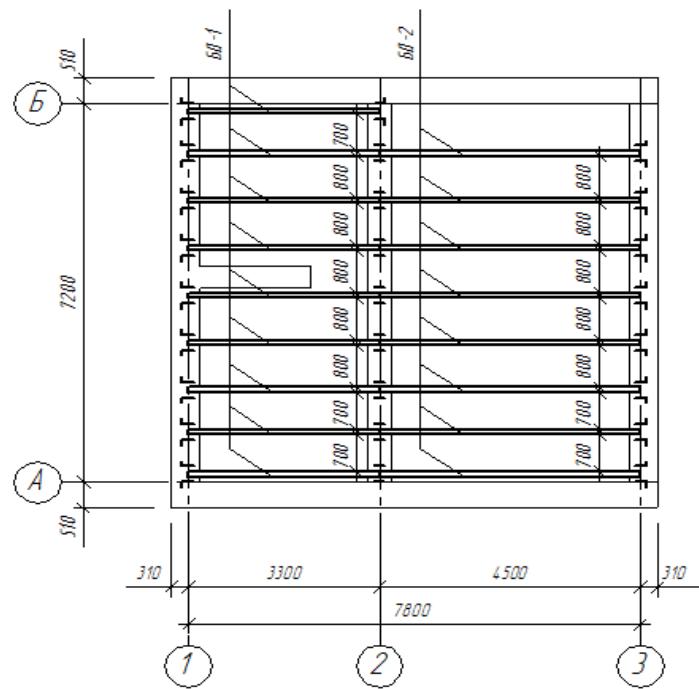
Пример выполнения плана перекрытий (балки)
